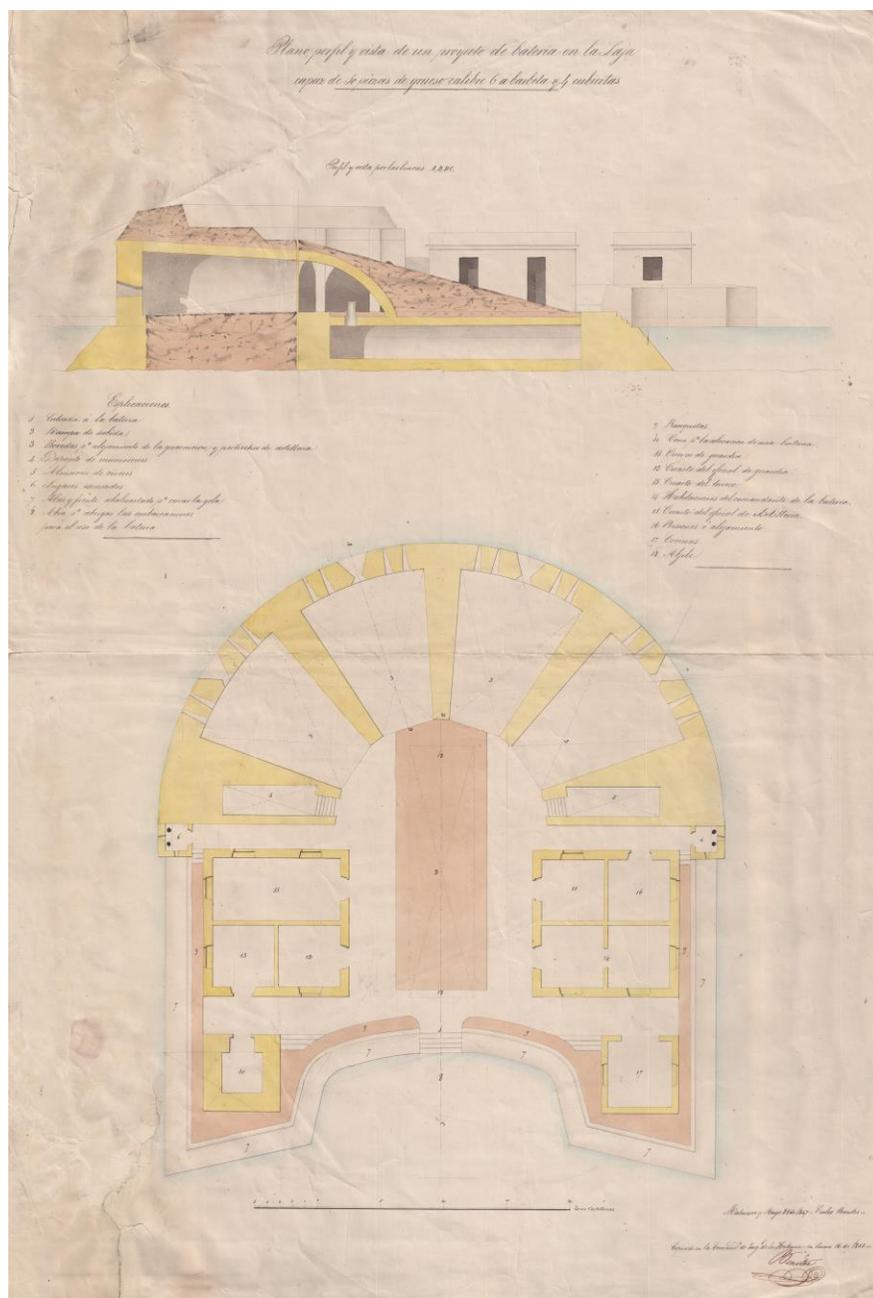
Plano, perfil y vista de un proyecto de batería en La Laja, con capacidad para 10 piezas de grueso calibre, 6 a barbata y 4 cubiertas. AGM, CUB-85-22
